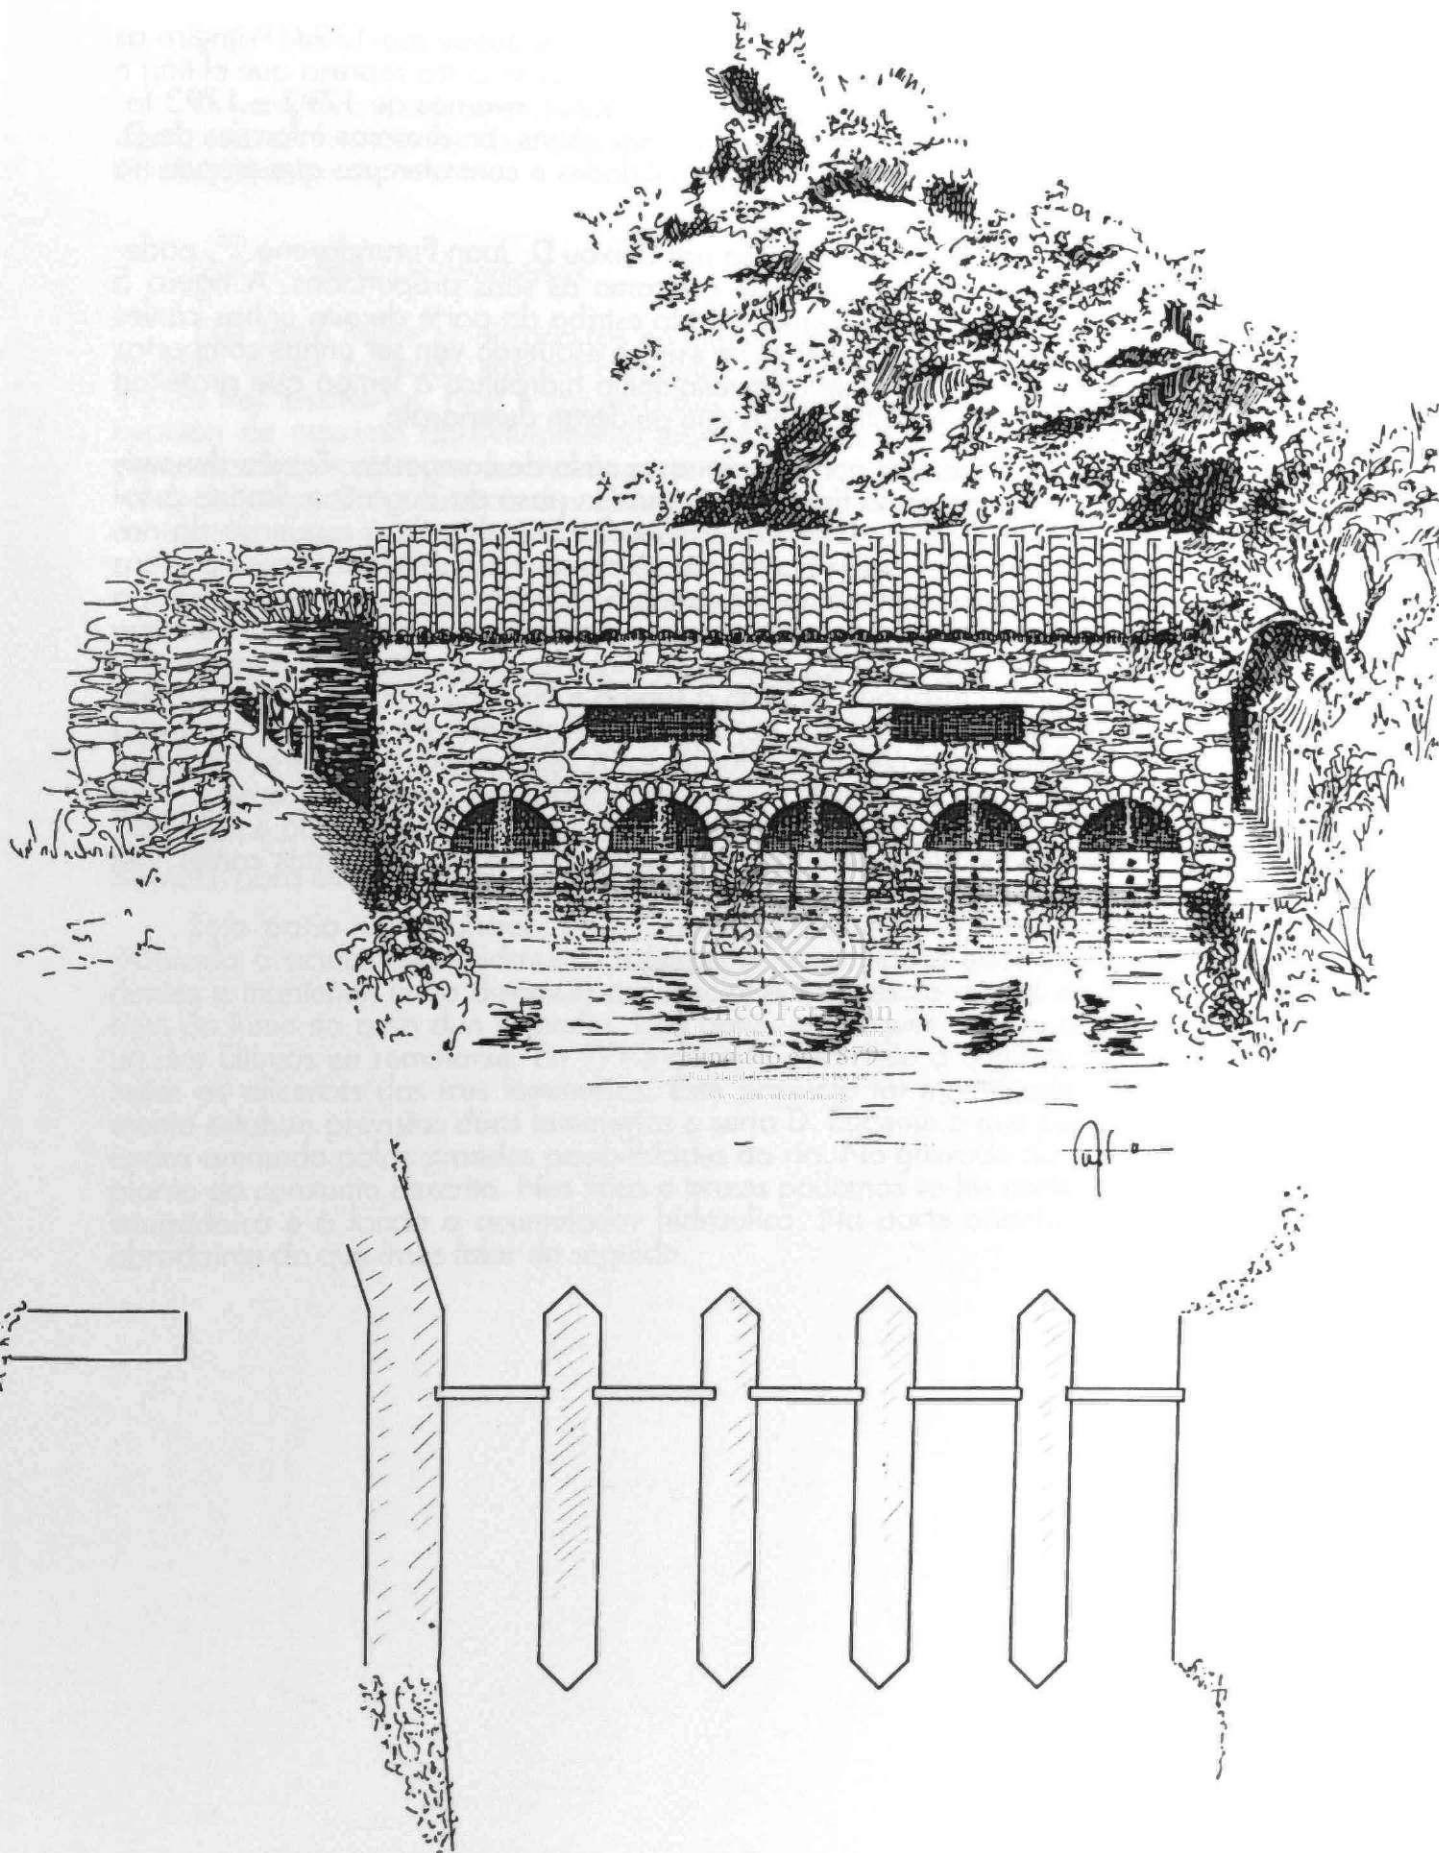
Alzado e planta da casa de comportas situada a carón da Presa do Rei.
